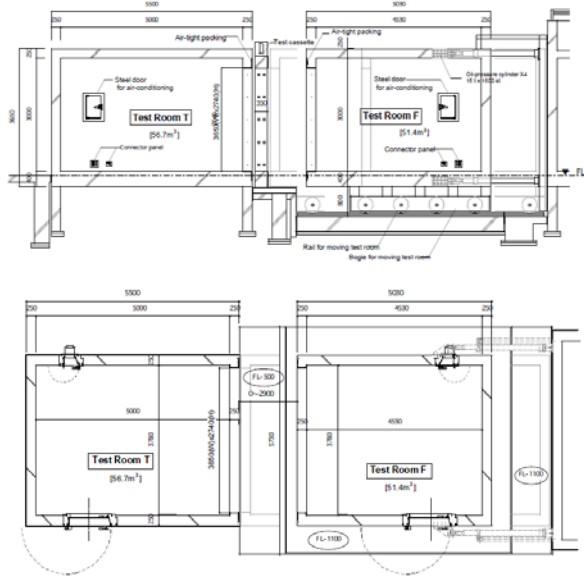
試験室の概略図 (上段：断面図、下段：平面図)
